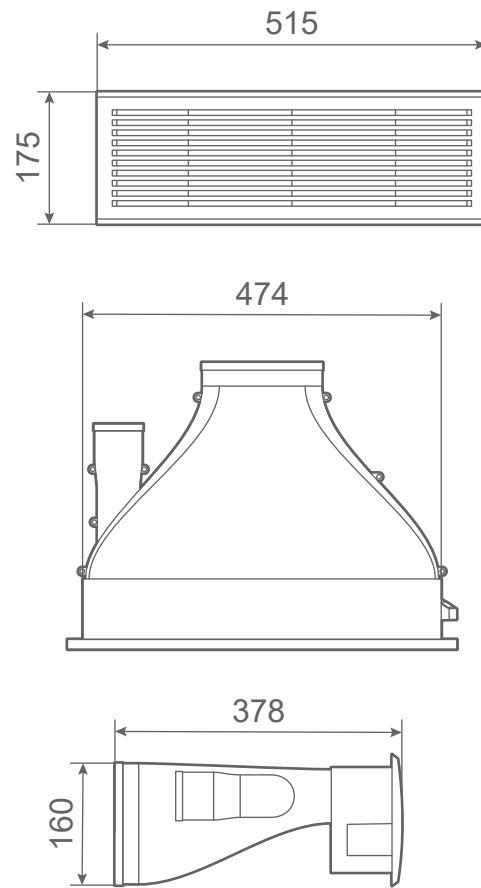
Grille et plénum de soufflage - dimension (en mm)
